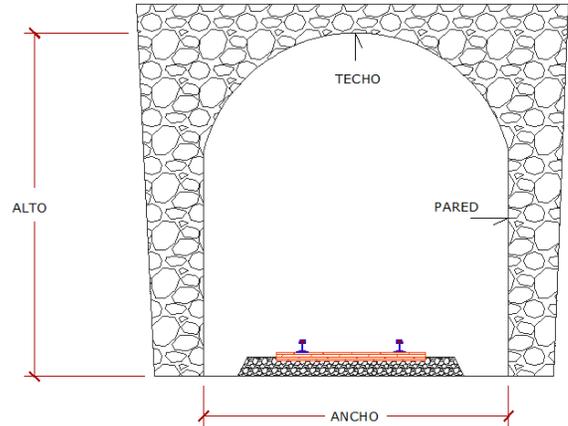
Detalle de sección en túnel. (Fuente: Autor)
